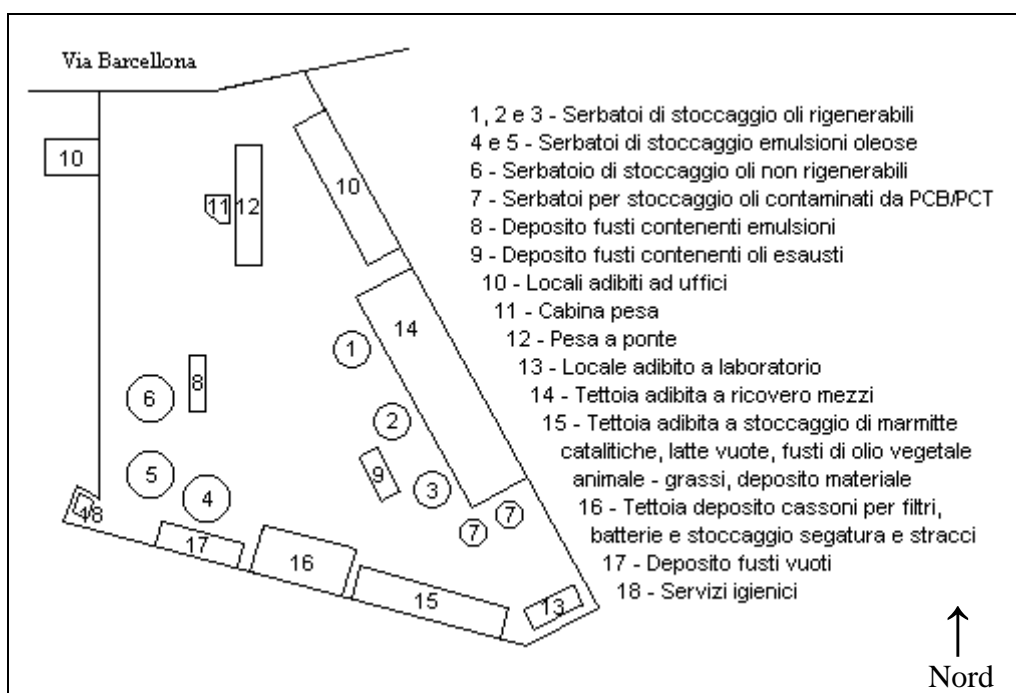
Pianta del sito. (Scala 1:800)
